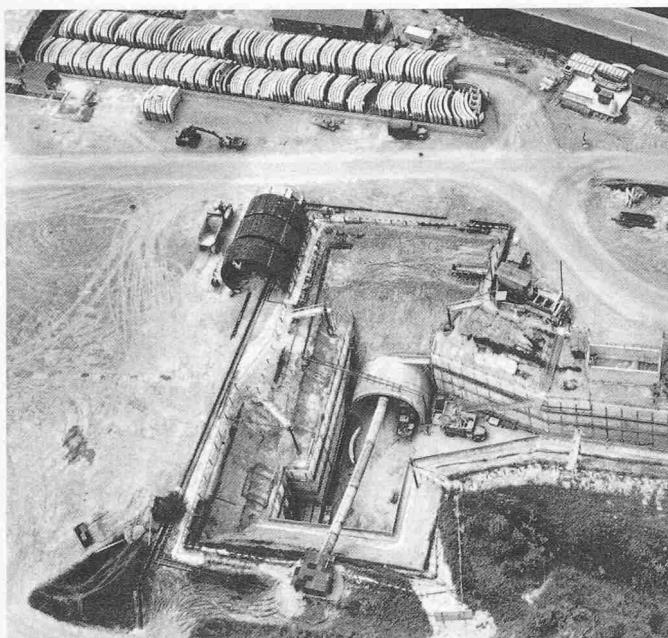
Los West. Zwischenangriffsstelle. Der Tunnelvortrieb in Richtung Bahnhof Zürich Flughafen ist bereits im Gange. Am oberen Bildrand: Lagerplatz der Tunnelauskleidungselemente (Tübbing) (Tübbing)
